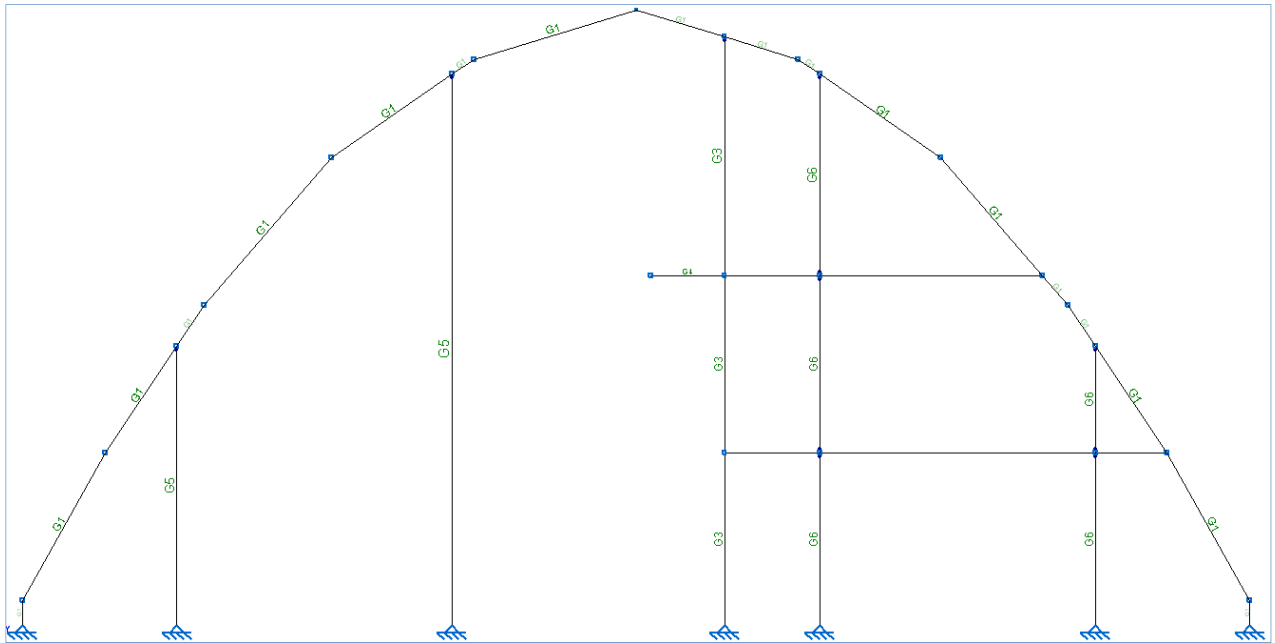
Hastiales de la parte derecha articulados en las vigas de forjado
